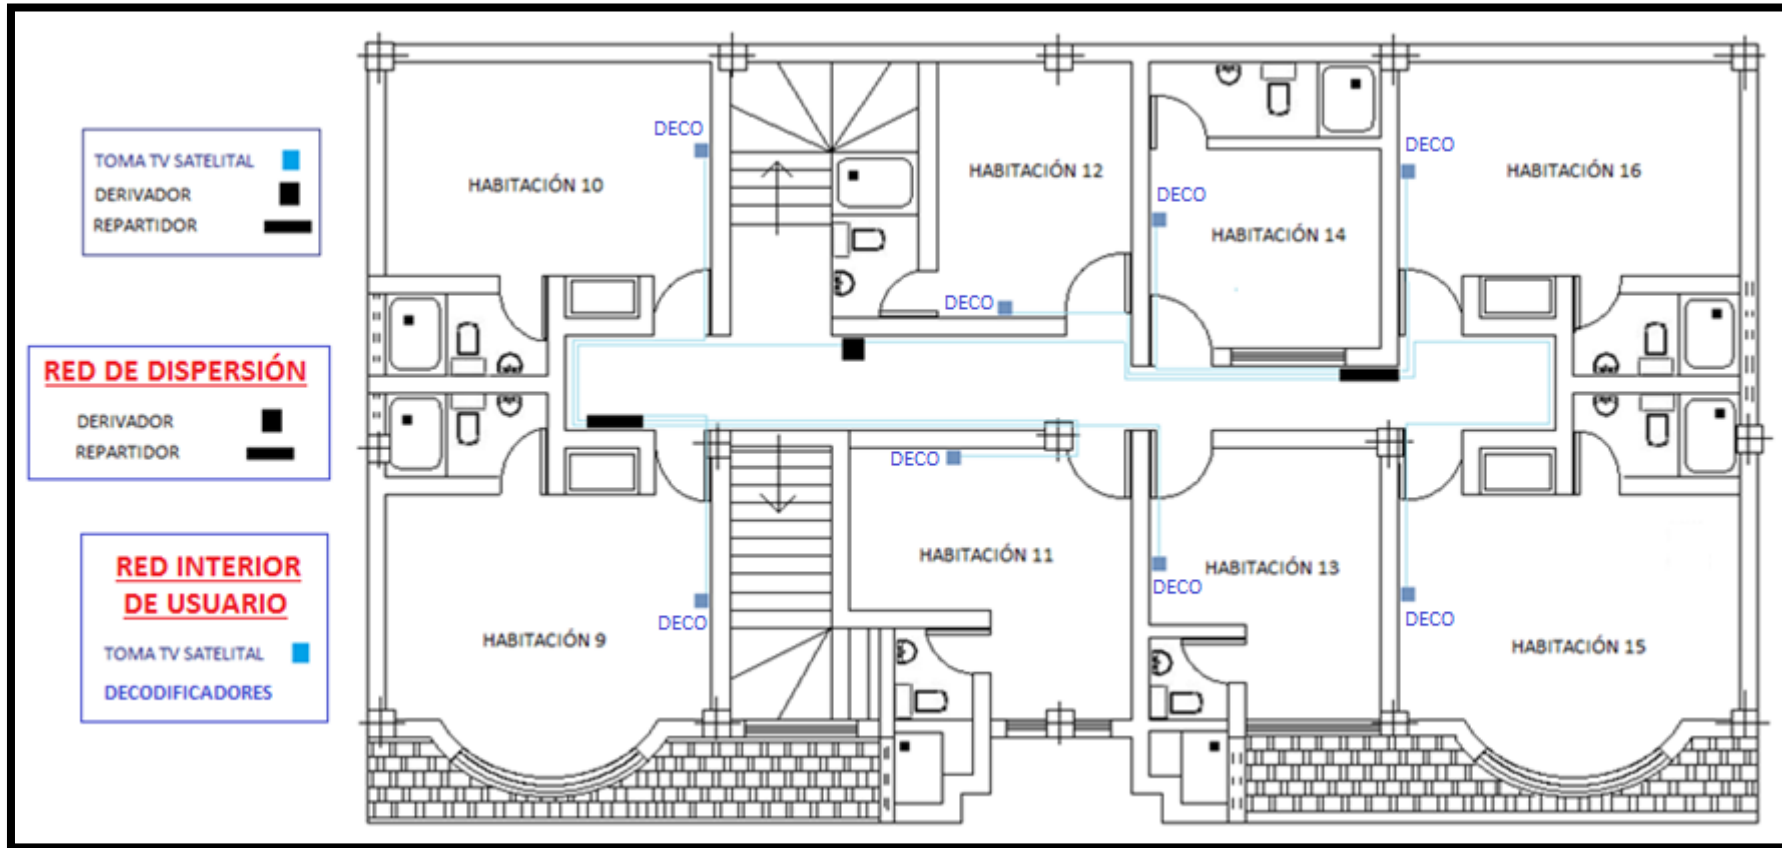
Puntos de TV satelital – Plano Segunda Planta
